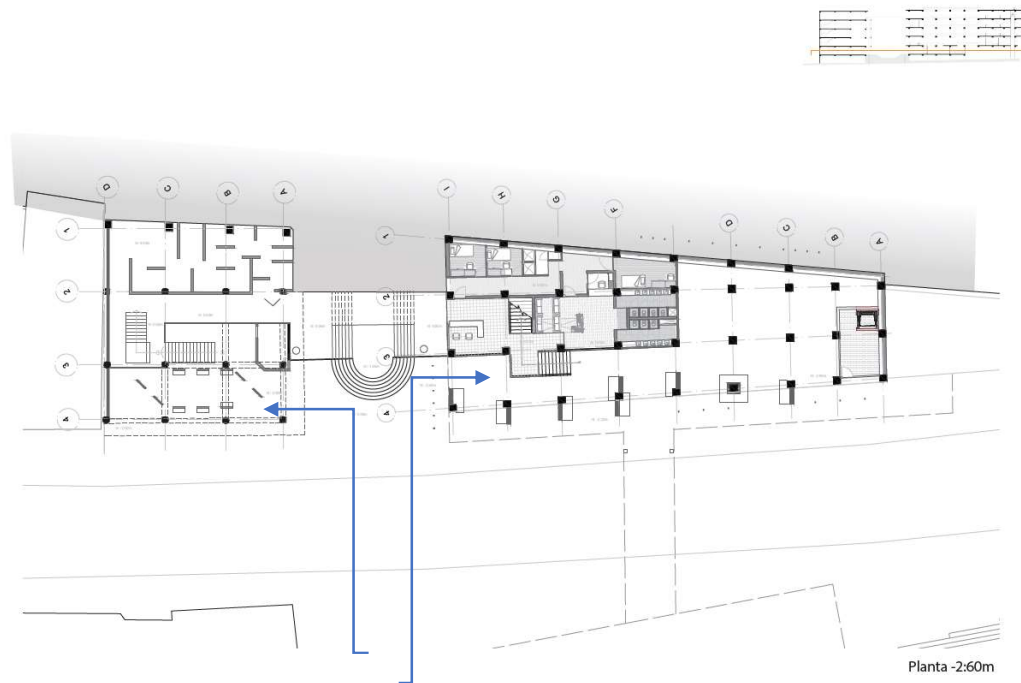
Planta Baja 10 de Agosto, (Elaborado por Loján, 2020)
